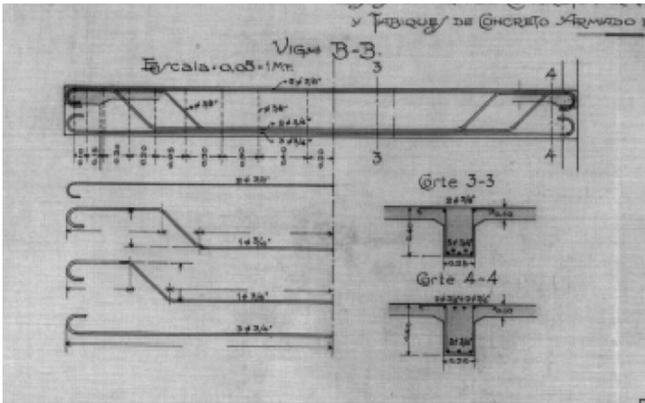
Detalle vigas y losas sistema Wayss Congreso Nacional. Fuente: Archivo DEPA MOP
